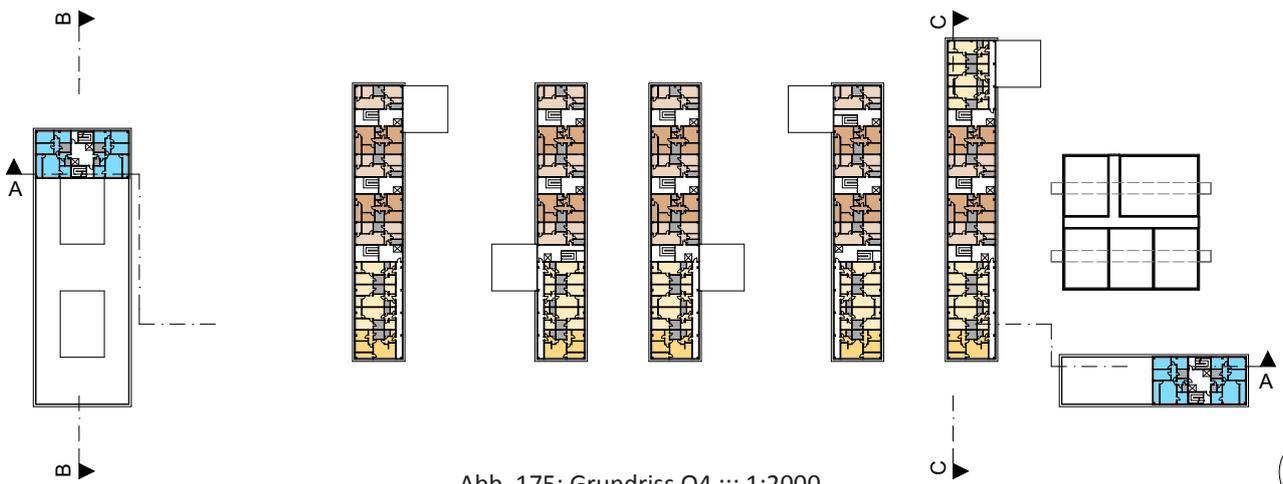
Grundriss O4 ::: 1:2000
